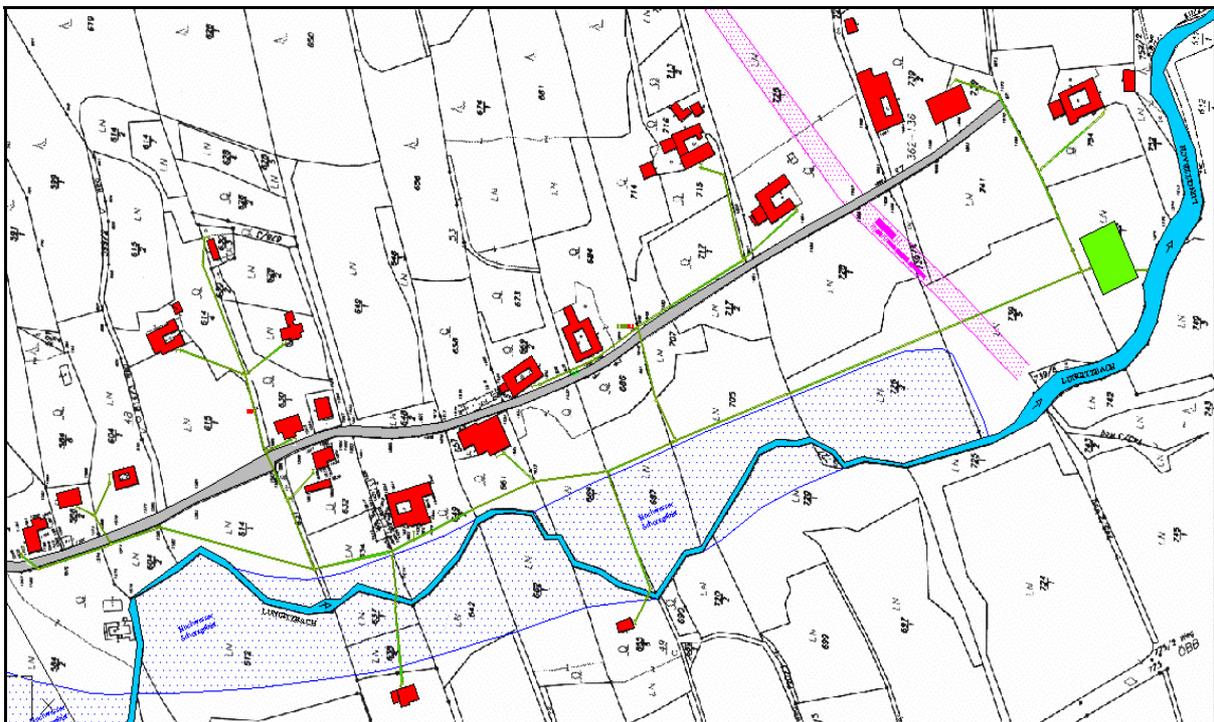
LAGEPLAN Variante 1 – eigene ARA Unterlechen
